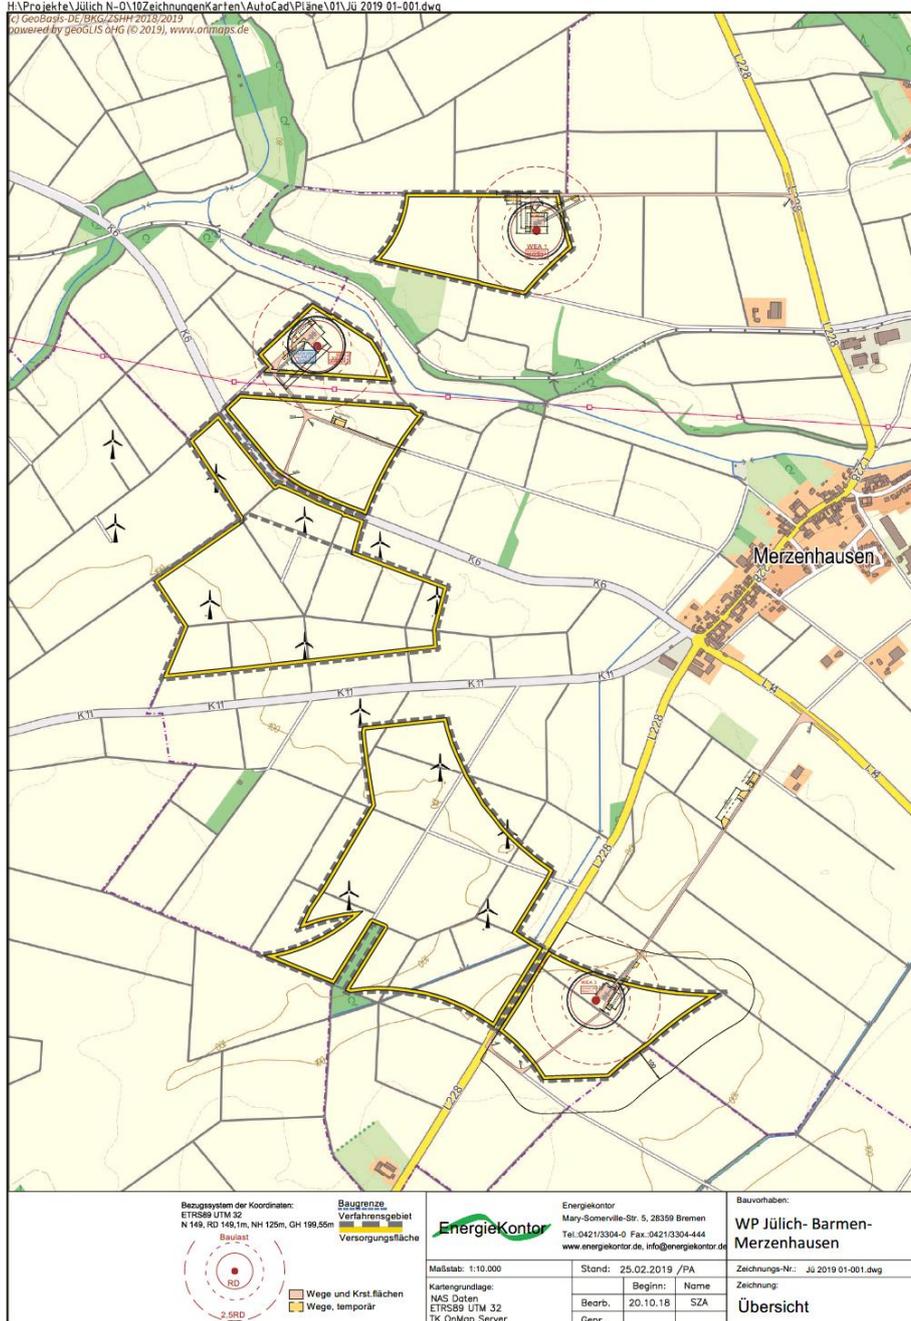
Lageplan Windpark Jülich-Barmen-Merzenhausen (nicht Maßstabsgetreu)
